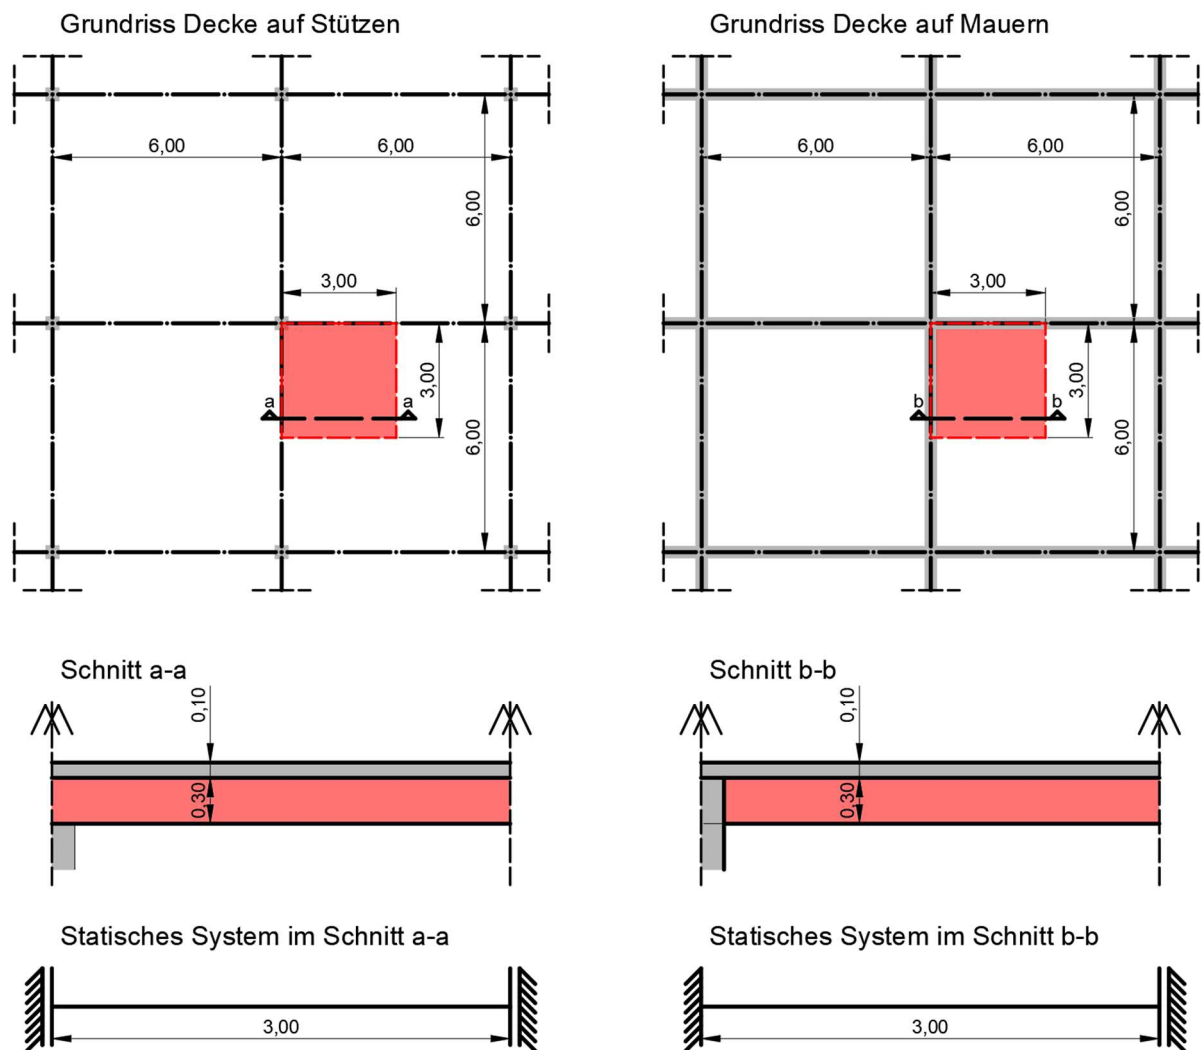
Untersuchte Decken im Grundriss und Schnitt, sowie entsprechendes statisches System. Das Design-Volumen ist mit Rot gekennzeichnet.
